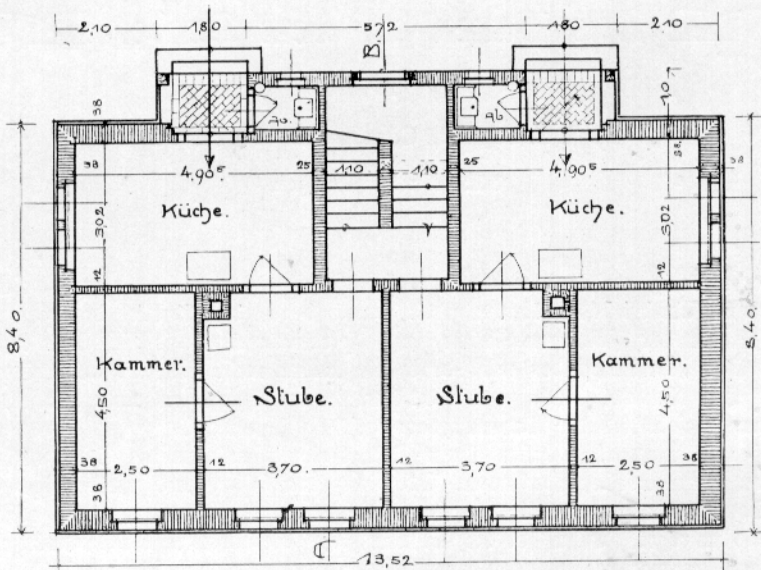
Erdgeschoßgrundriß eines Doppelwohnhauses für vier Familien auf Kammergut Roffen.
